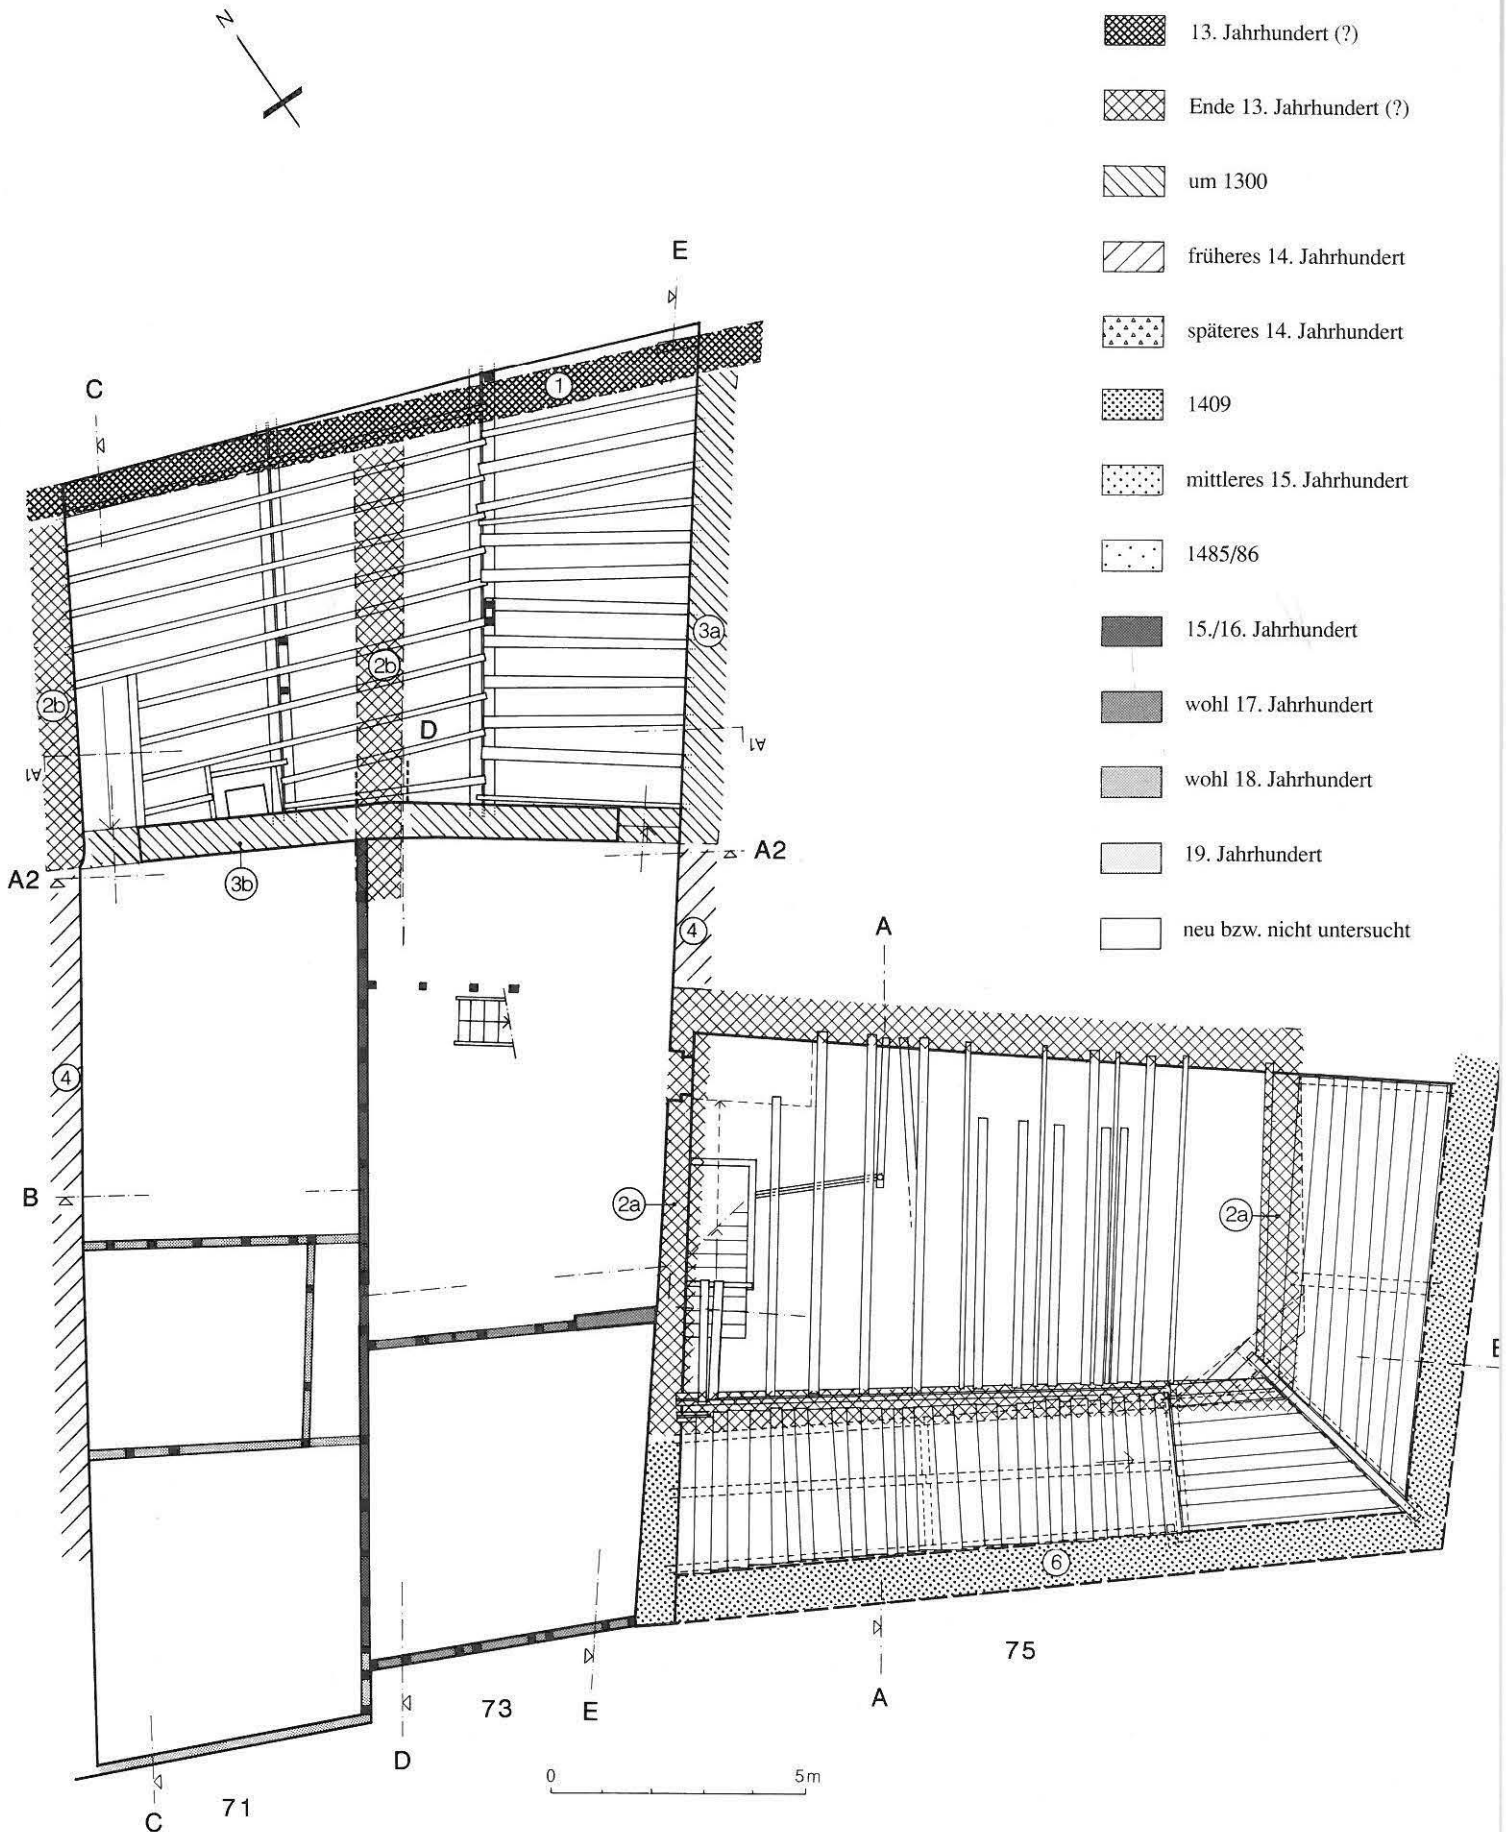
Bälliz 71–75. Grundriss des 1. Obergeschosses mit Bauperiodisierung. Massstab 1:150.
